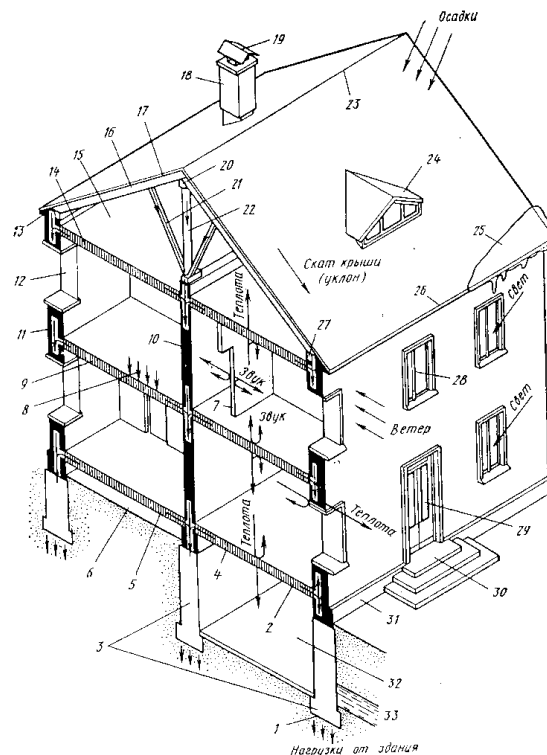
Основные конструктивные элементы здания с кирпичными несущими стенами: 1 — подложка фундамента; 2 — подвальное перекрытие; 3 — фундаменты; 4 — цоколь; 5 — явное перекрытие; 6 — подполье; 7 — перегородка; 8 — нагрузка от собственной массы, людей и оборудования; 9 — междуэтажное перекрытие; 10 — продольная внутренняя стена; 11 — стена; 12 — оконный проем; 13 — карниз; 14 — чердачное перекрытие; 15 — чердак; 16 — стропильная балка; 17 — кровля; 18 — дымоходная труба; 19 — вент; 20 — коньковый прогон; 21 — полное; 22 — стойка; 23 — колен; 24 — службовый свес; 25 — свес; 26 — карниз; 27 — мауэрлат; 28 — оконный перелет; 29 — дверное полотно; 30 — крыльцо; 31 — цоколь; 32 — подвал; 33 — грунтовая влага
